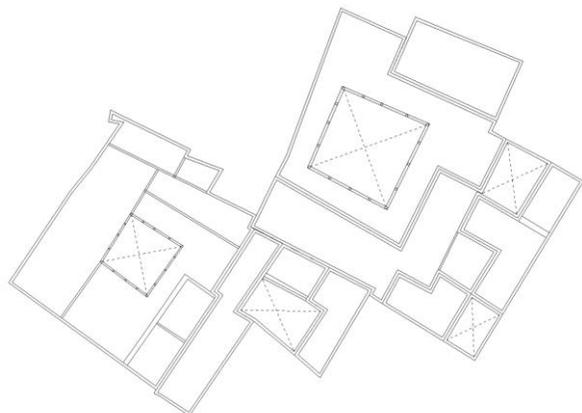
Casa de los Moreno de la Cova - Planta baja.
